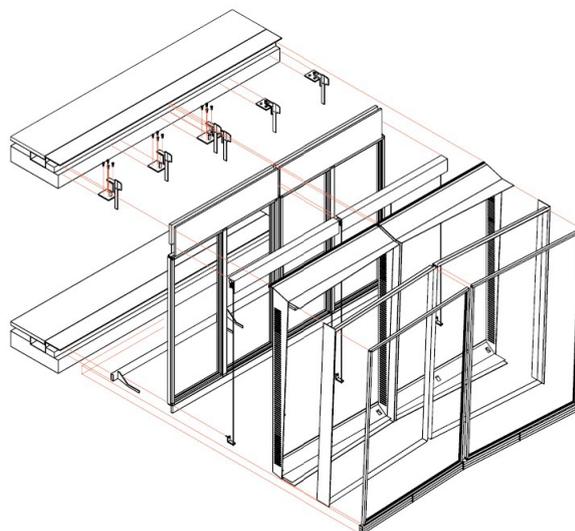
Explosionszeichnung Elementfassade (Auer et al., 2007)
